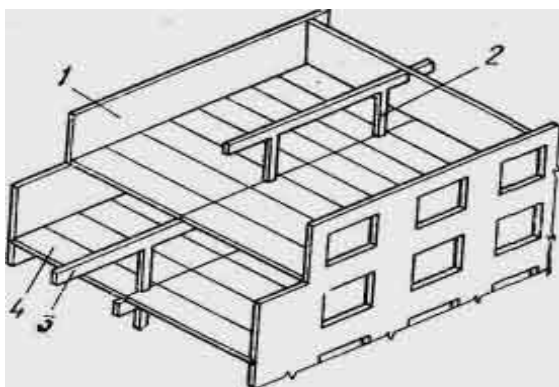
Элементы, обеспечивающие пространственную жесткость зданий с неполным каркасом: 1-несущая стена; 2-внутренняя колонна; 3- ригель; 4 – перекрытие
